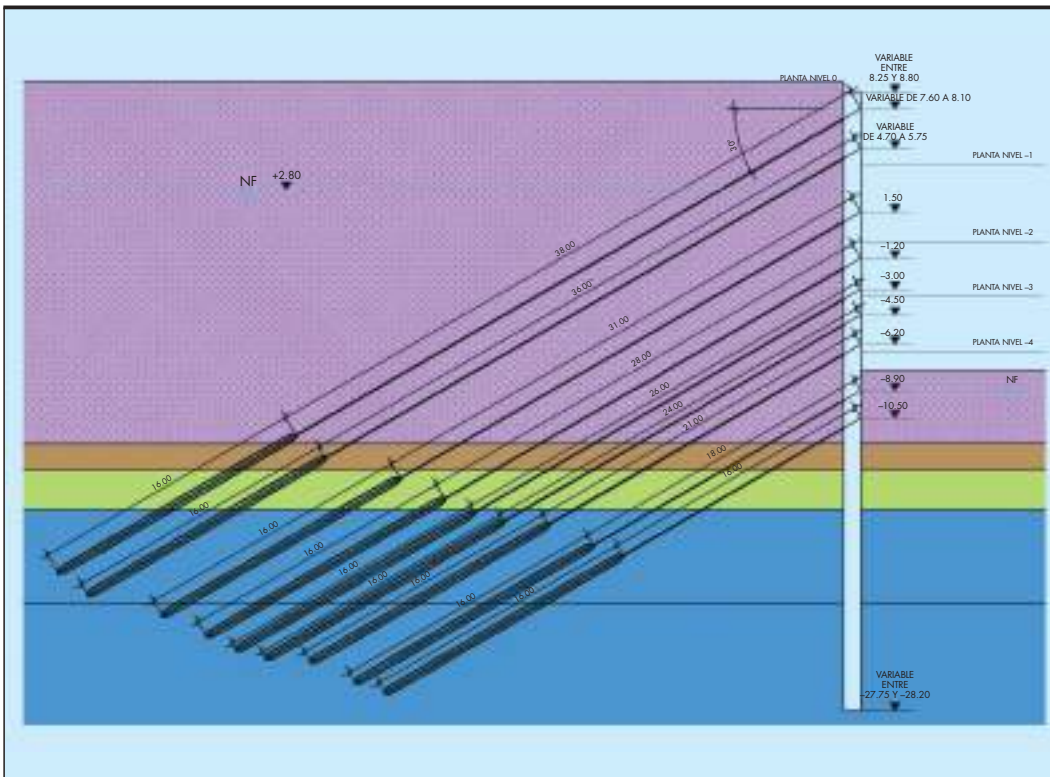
Detalle de la sección con mayor número de niveles de anclajes por sobre-excavación en la zona de la Corta de Triana.
